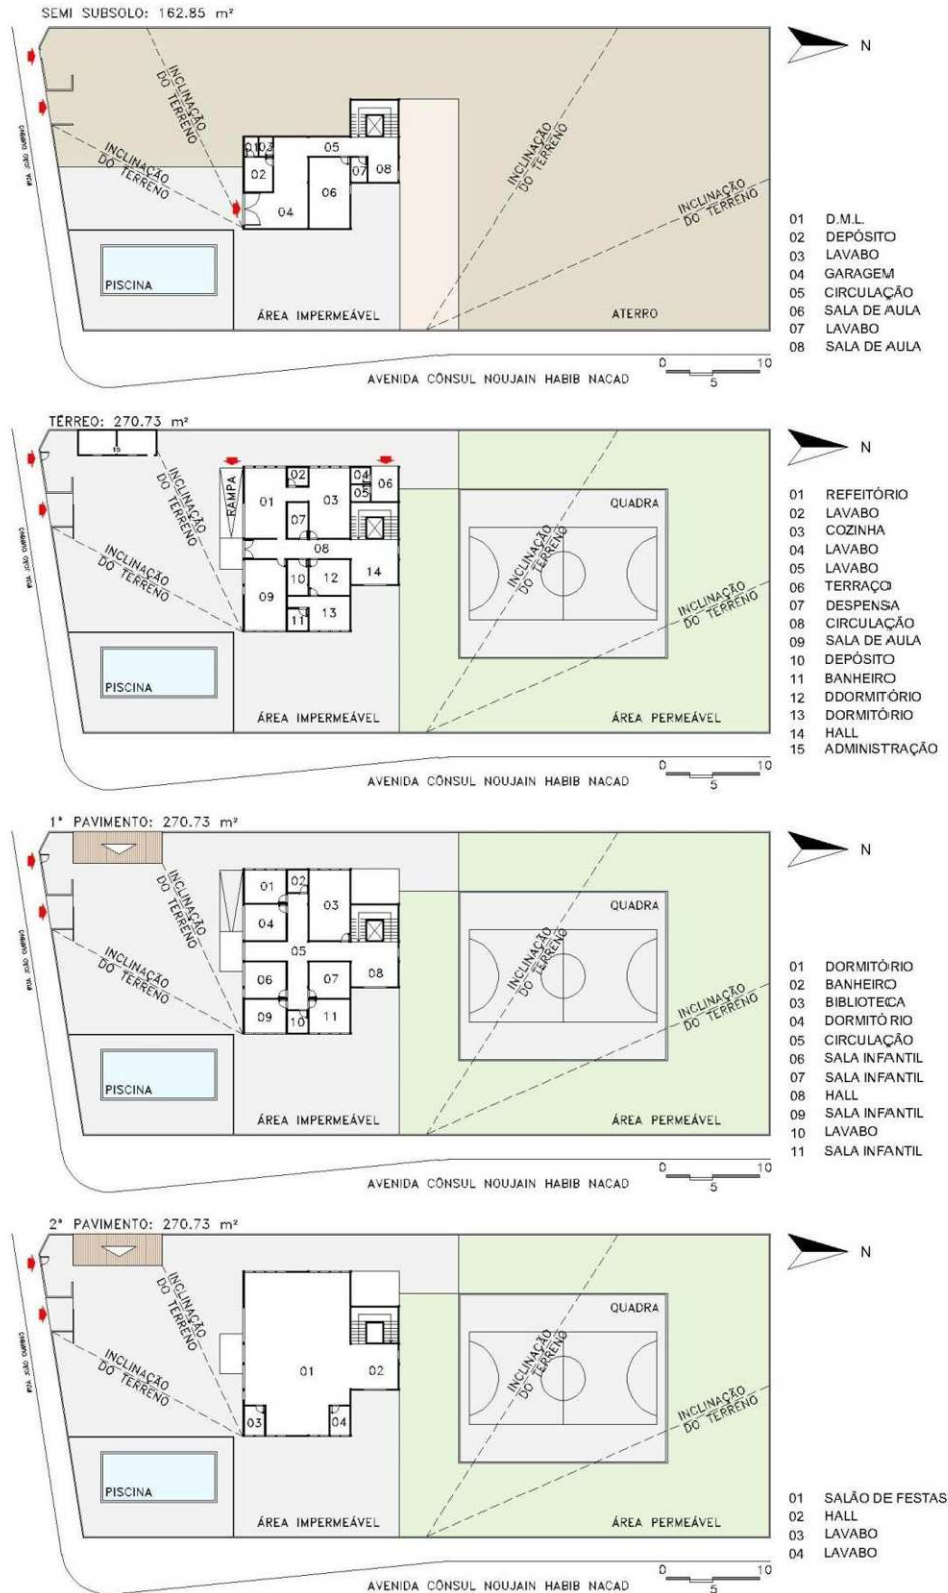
Plantas dos pavimentos da situação atual (Fonte: G1.com; Arquivo pessoal)
